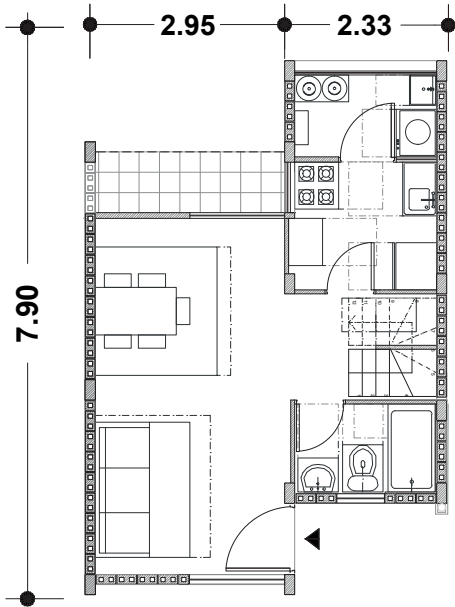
Vivienda duplex. Elaboración Propia en base a Planimetrías
